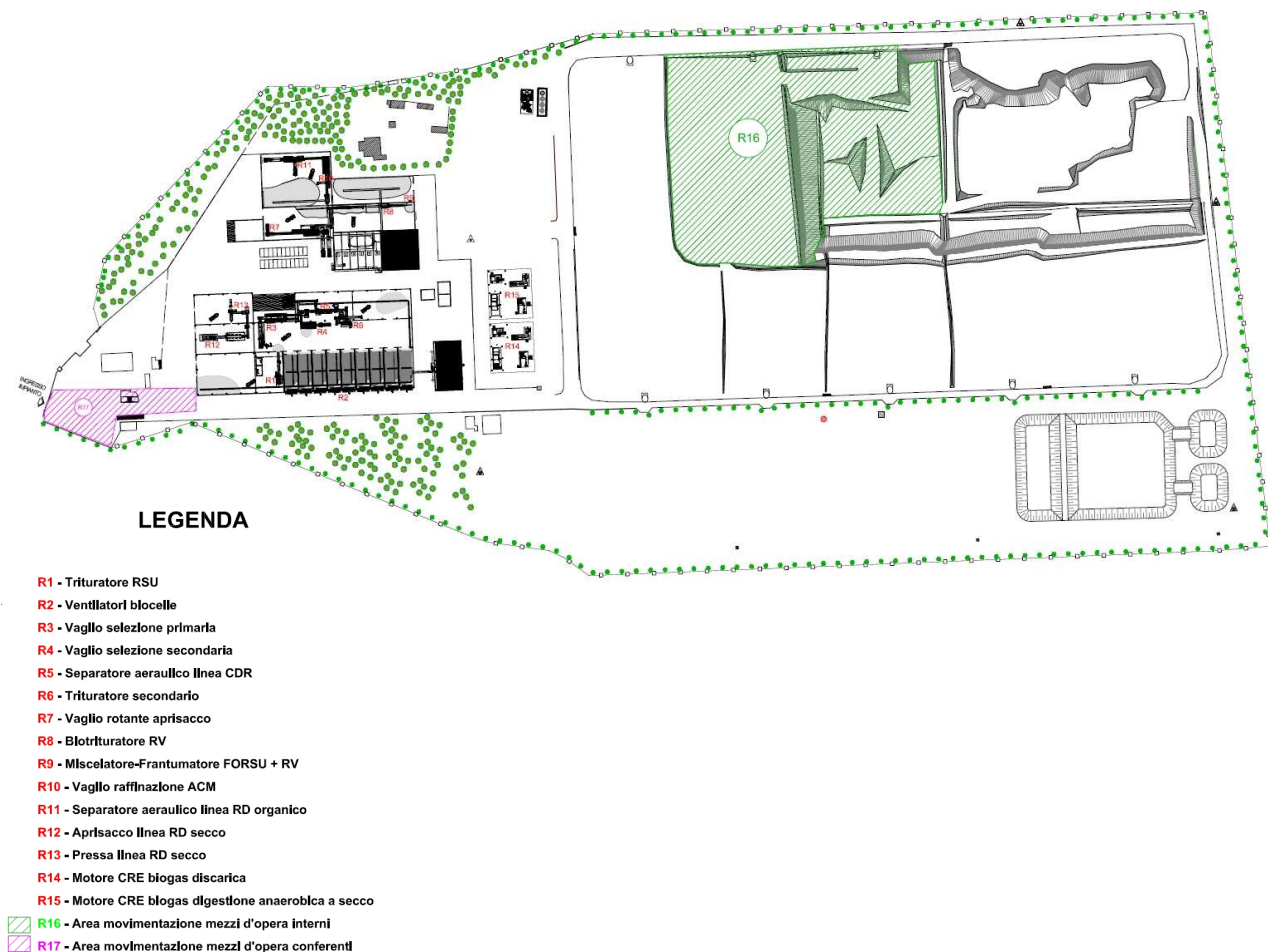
Planimetria del sito con ubicazione delle sorgenti di rumore Traffico e viabilità
